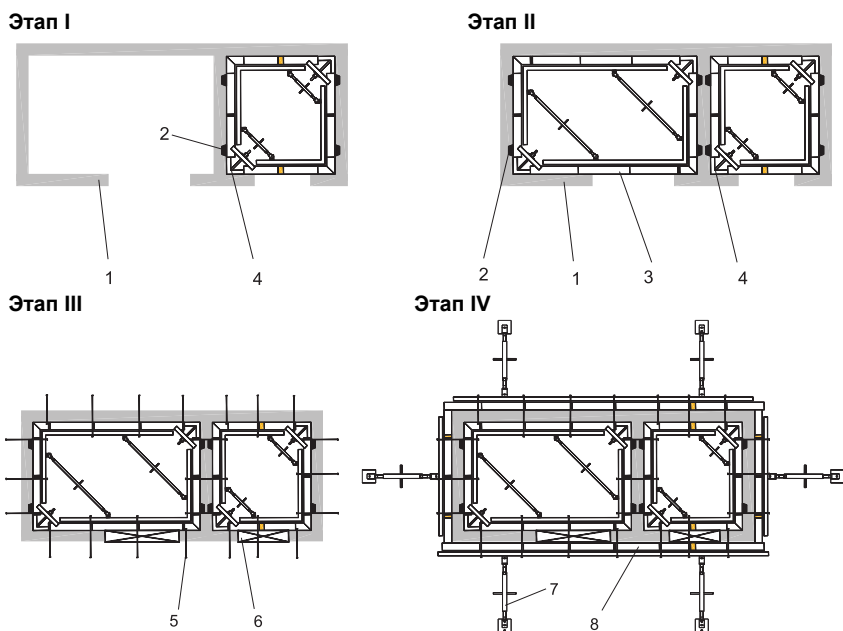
Последовательность монтажа опалубки шахт лифтов:
